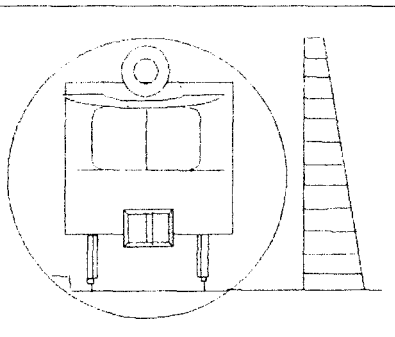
Сечение тоннеля и эпюра ветровой нагрузки
